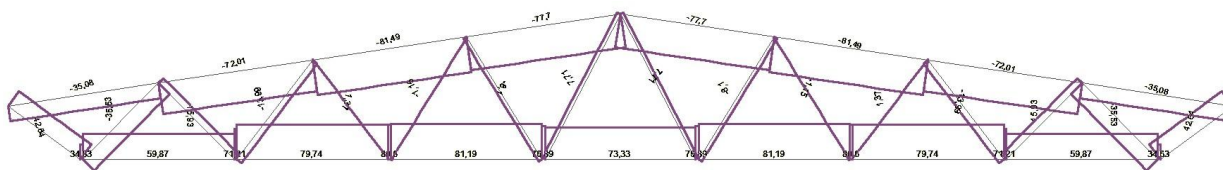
Эпюра изгибающих моментов стропильной фермы с уклоном верхнего пояса 15 %
